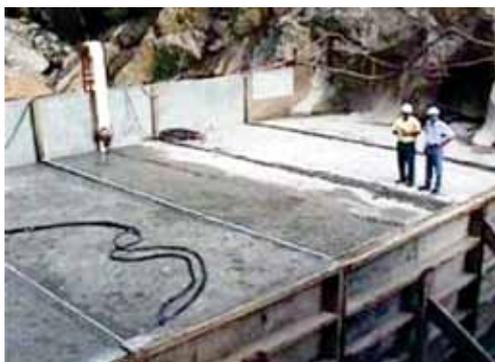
Faixa de georrede longitudinal instalada como coletor no pé da barragem de CCR de Boussiaba, Argélia
